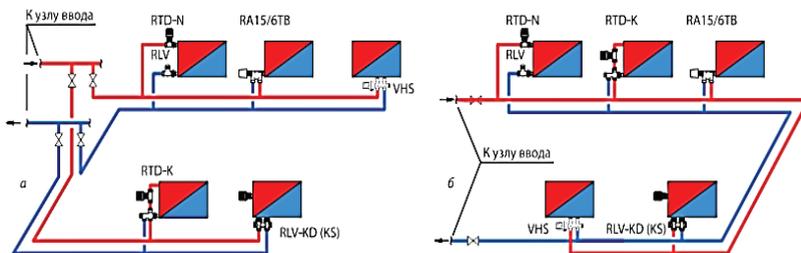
Двухтрубная периметральная разводка квартирных трубопроводов:
